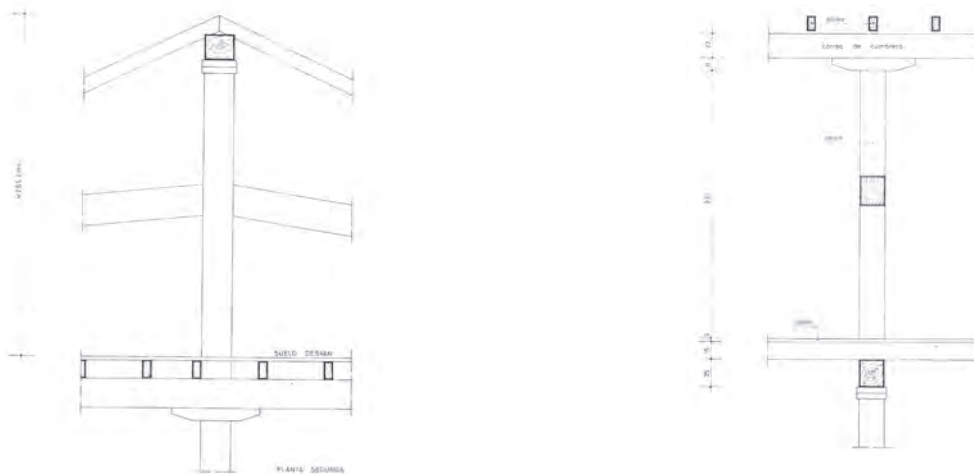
26. SECCIÓN CONSTRUCTIVA PERPENDICULAR A VIGA CUMBRERA FIGURA A17. 27. SECCIÓN CONSTRUCTIVA PARALELA A VIGA CUMBRERA
